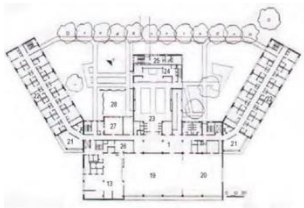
| Planta piso tipo do Projeto St. Vincent.
